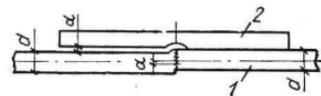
Определение смещения осей стержней, соединенных контактной сваркой
